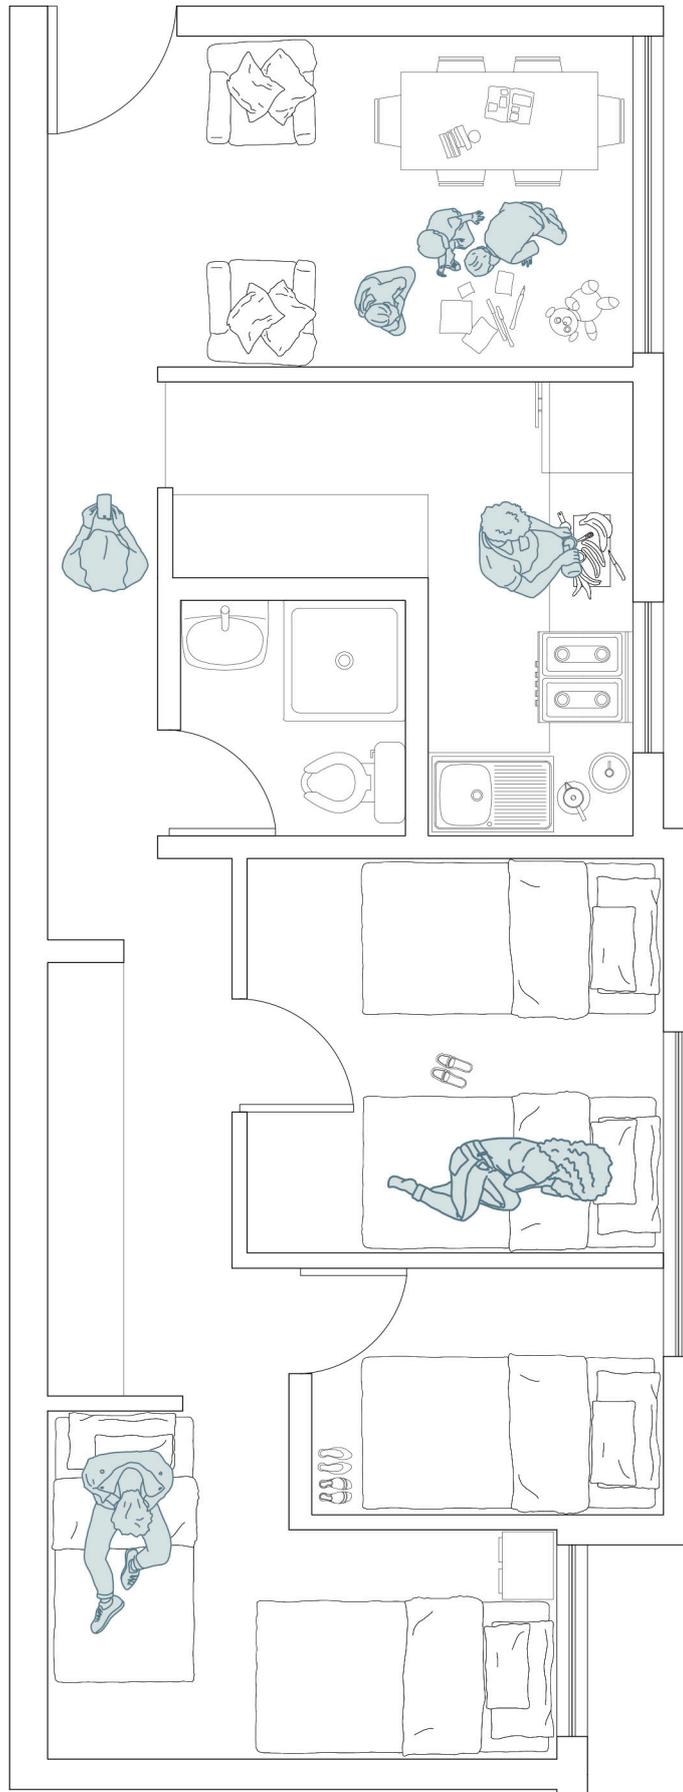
Planta de detalle de una unidad de departamento en Villa el Volcán III.
